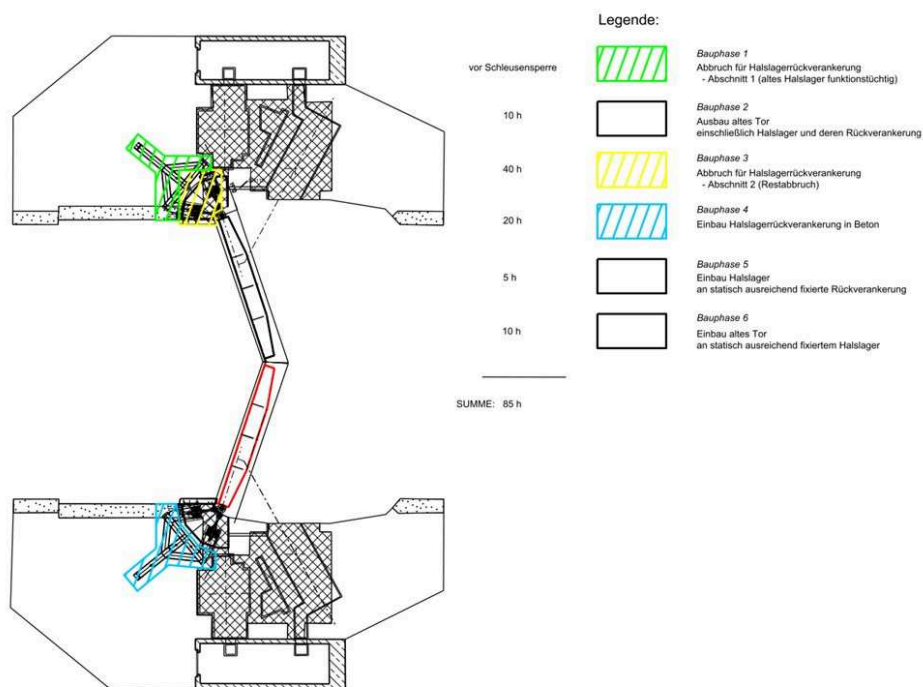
Bauphasenplan 1 Ersatz der Halslager einschl. deren Rückverankerung
